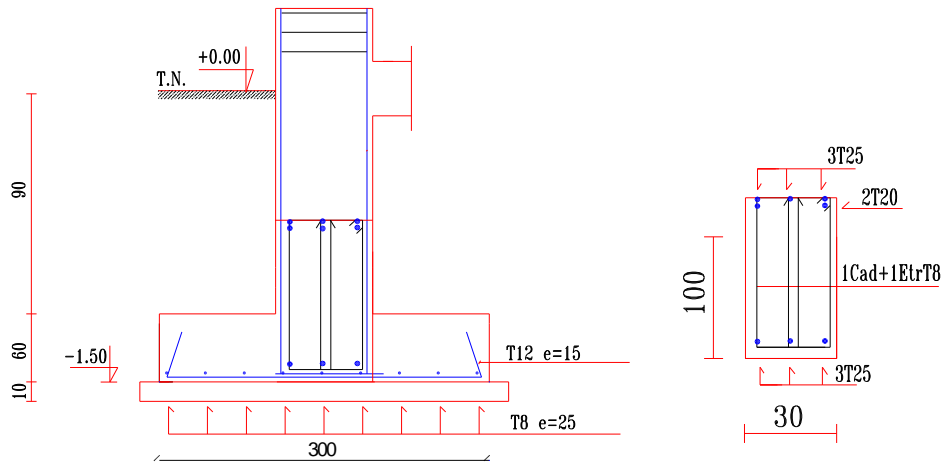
Schéma de ferrailage des semelles filantes travier X-X
